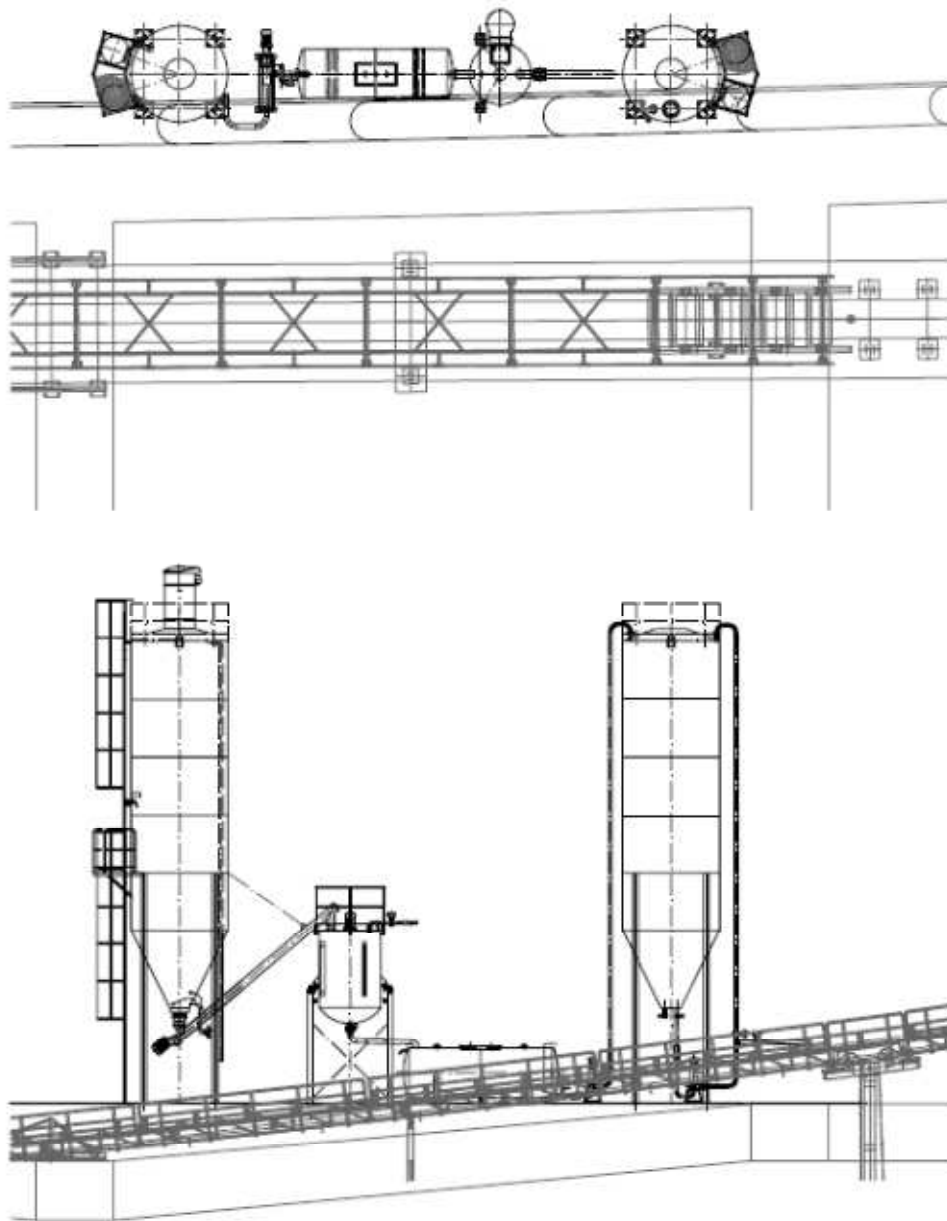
Croquis en planta y perfil de la planta de fabricación de Bentonita.
